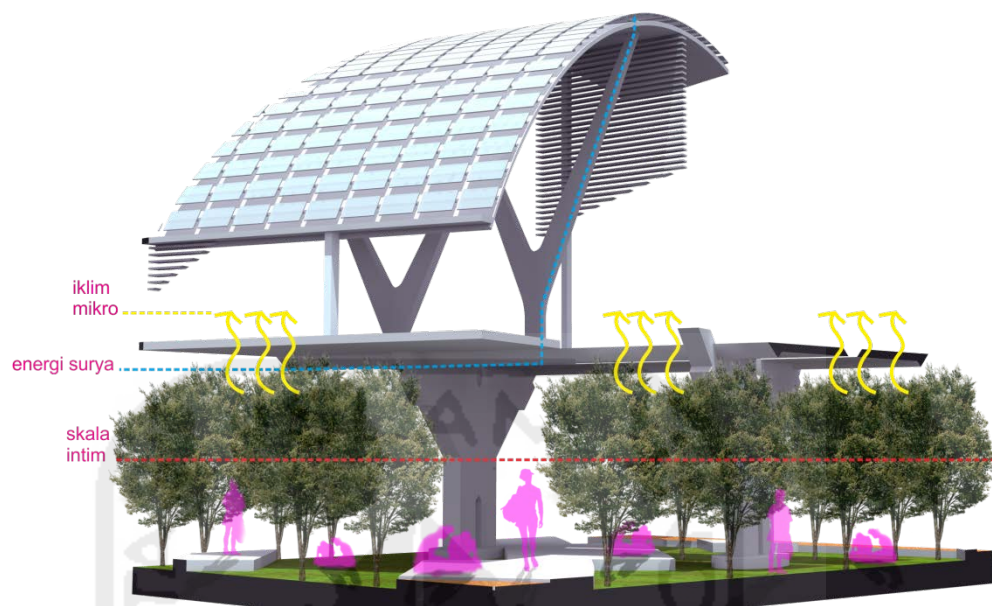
Skematik struktur bangunan stasiun MRT (potongan membujur)
